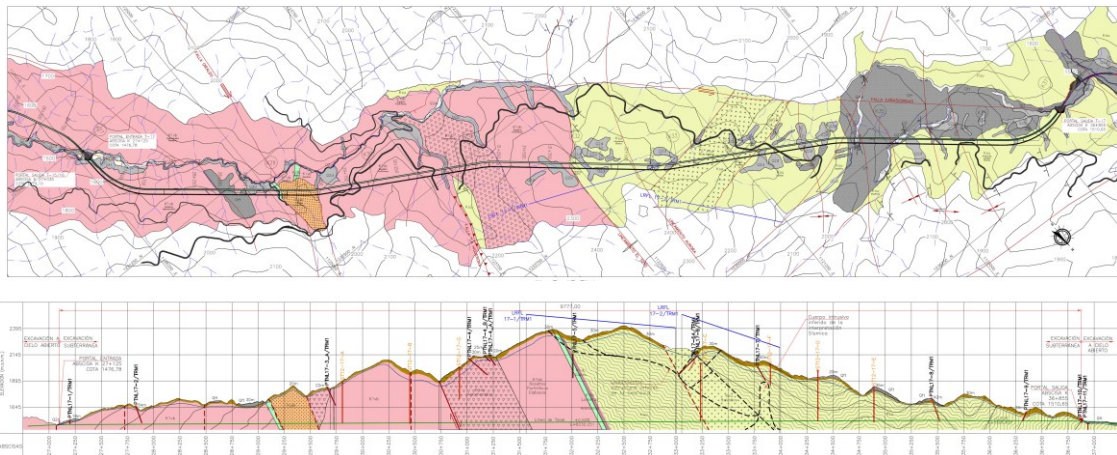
Planta y perfil geológico del túnel del Toyo.
